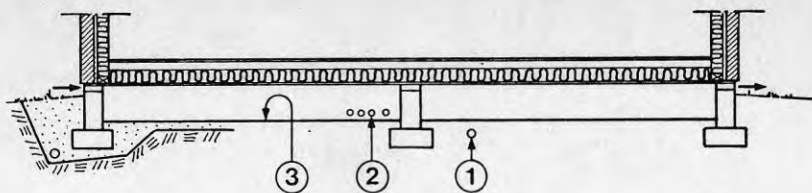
Inneluftsventilerat kryputrymme. Detalj.
